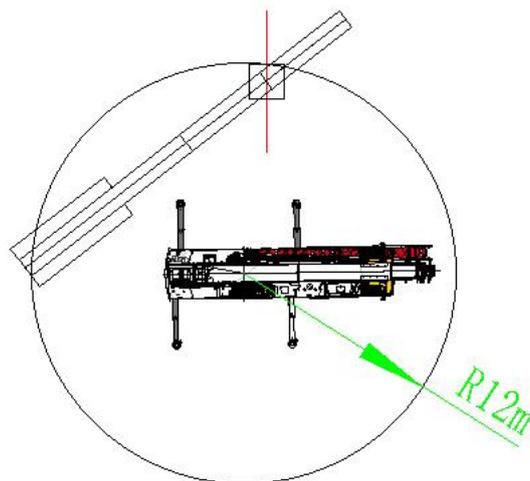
塔吊平衡臂吊装平面示意图
